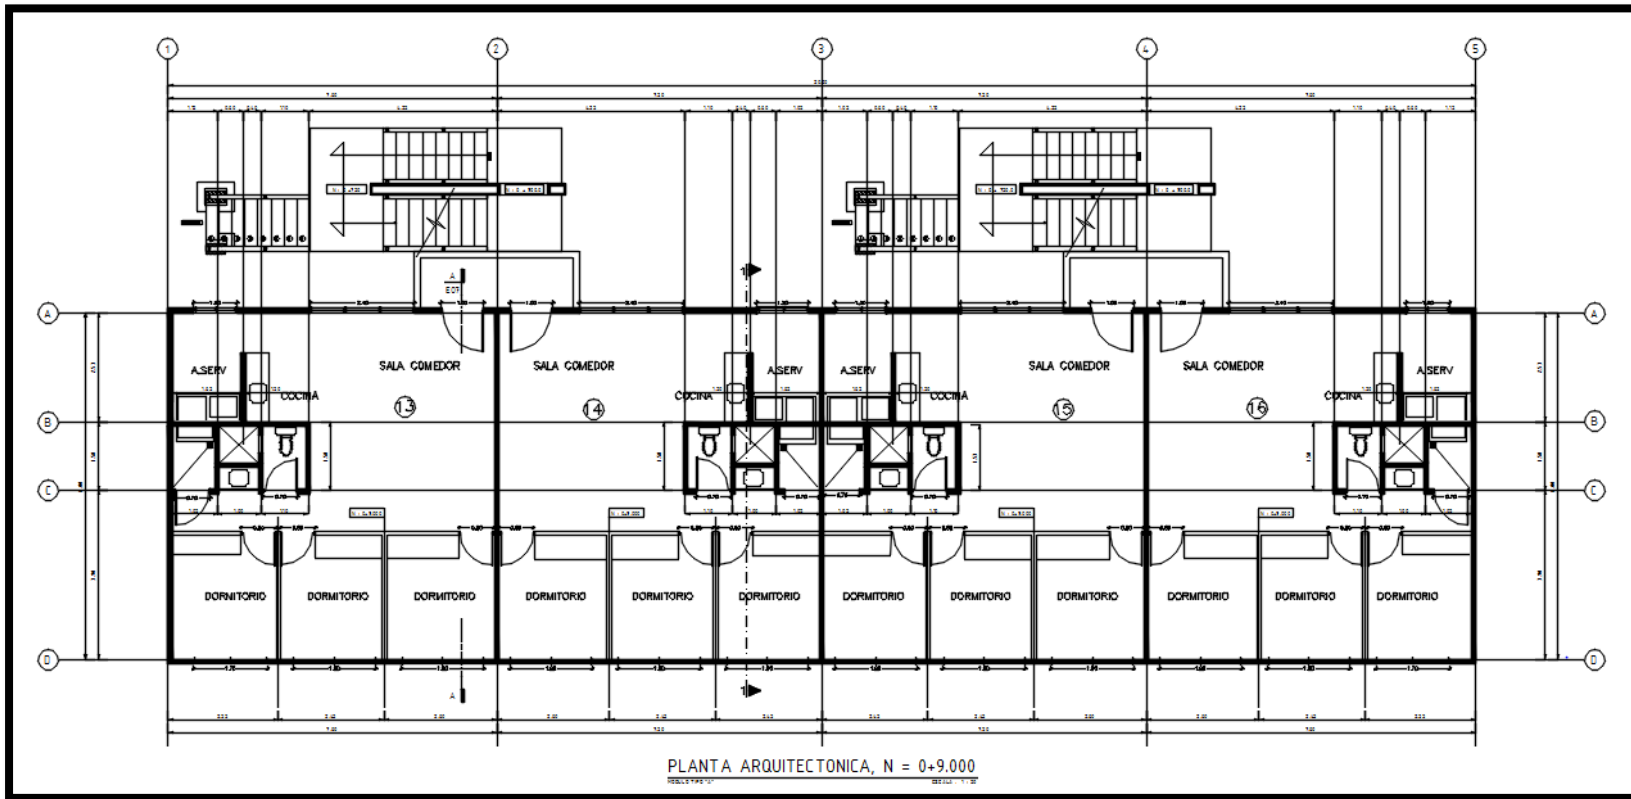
Planta Arquitectónica (Elevación 0 + 9.000)
